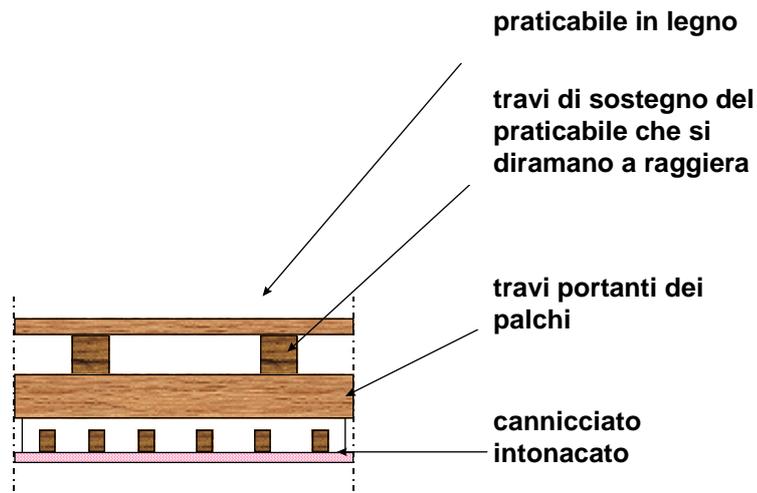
SEZIONE PAVIMENTAZIONE PALCHI
